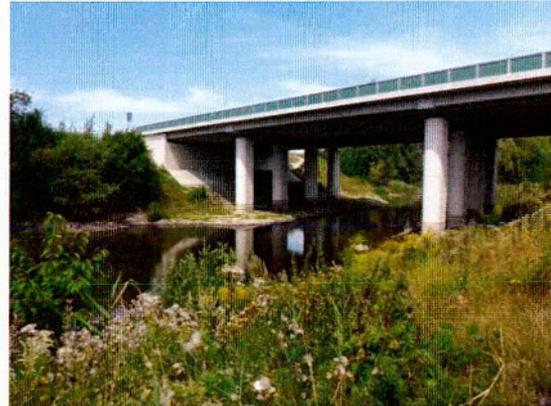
Bubendorfer Wasserloch und Bauwerk 47 der BAB 72, an den Brückenpfeilern ist die ehemalige Einstauhöhe gut ablesbar
